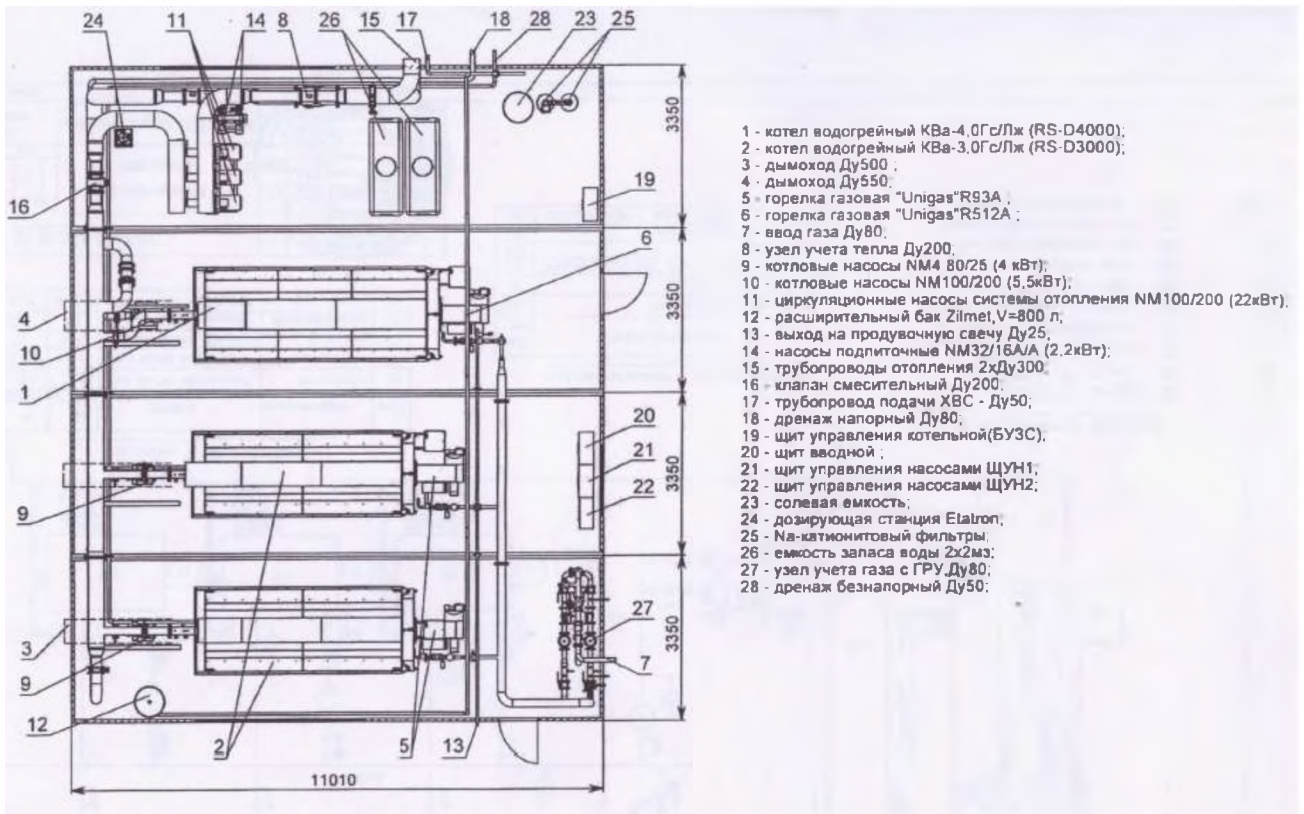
План расположения оборудования котельной «мкр. Звездный»
